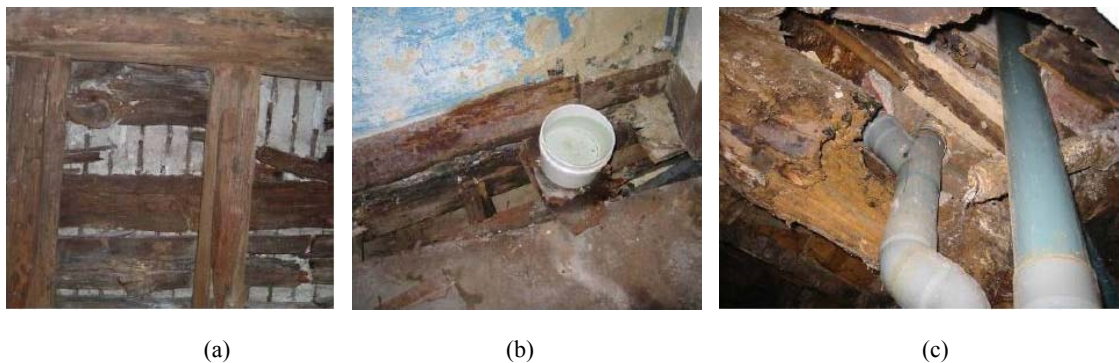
(a) degradação do pavimento devido à construção da lajeta de betão; (b) degradação do pavimento devido à rotura de canalizações [33].
